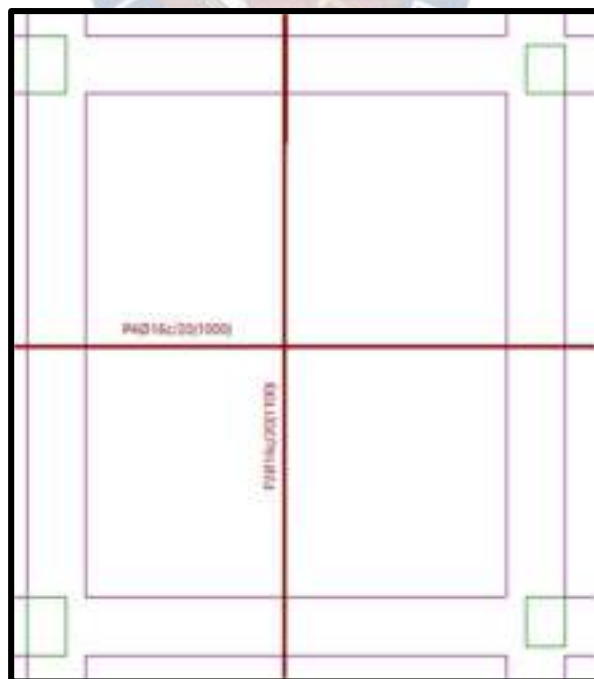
Esquema de armado longitudinal y transversal superior de la losa de Cimentación s/ CBH – 87
